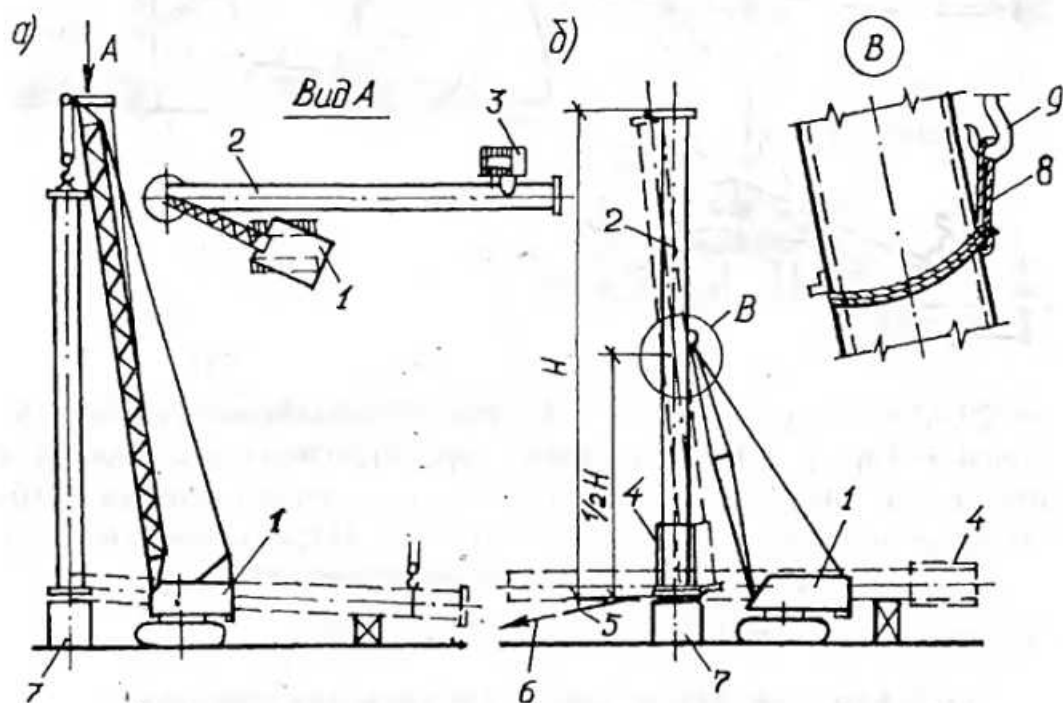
Схема монтажу сталеві димові труби одним краном: а) стропування труби за головку; б) стропування труби нижче від її середини; 1 - кран; 2-димова труба; 3-трубовкладальний кран; 4-контрвантаж; 5-тяговий канат; 6-відтяжка; 7-фундамент труби; 8-строп; 9-чалочний гак крана
